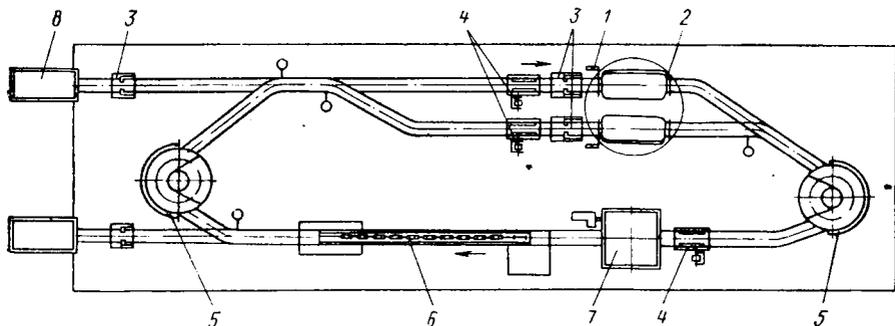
Кольцевая схема откатки вагонок с поворотными платформами:
